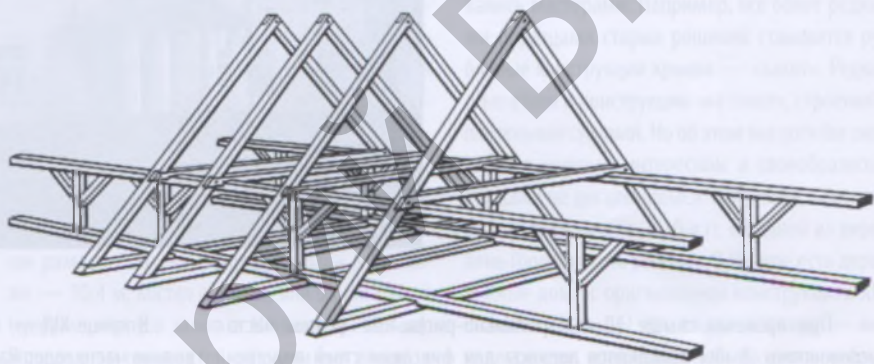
Конструкция крыши со стропильно-ригельной фермой, у которой ригель поддерживается двумя подстропильными рамами. Усадебный дом в Гнезно Волковысского района, начало XIX в.
